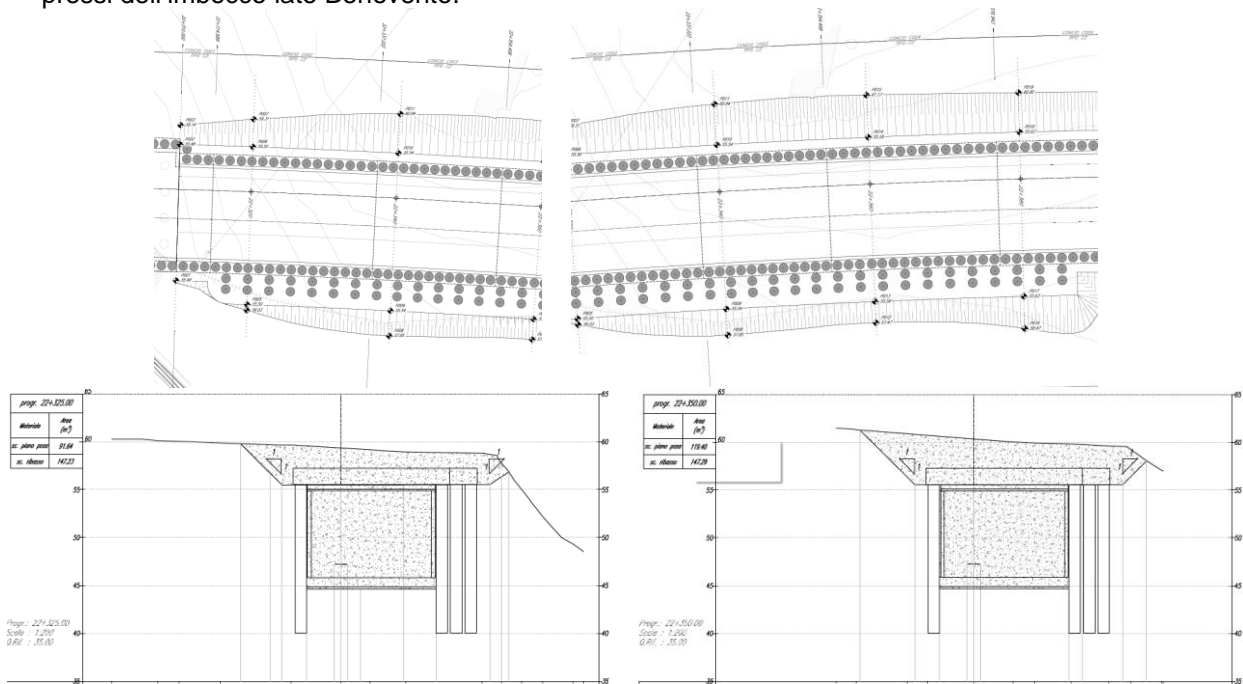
Stralcio della pianta scavi e delle sezioni dell'imbocco Sud (Rif. [VIII] e Rif. [IX])
